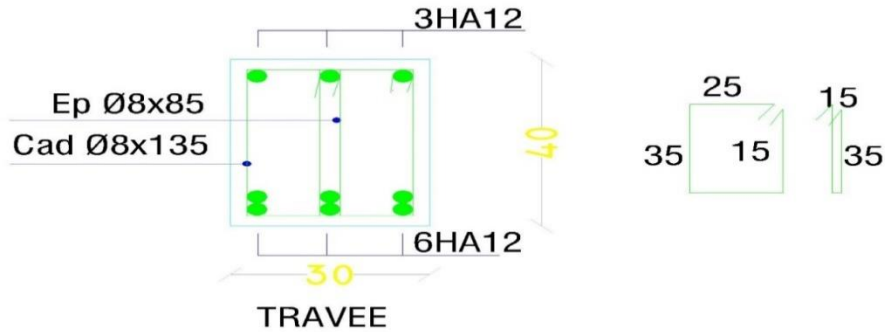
Ferraillage poutre secondaire au niveau terrasse et EC, en
